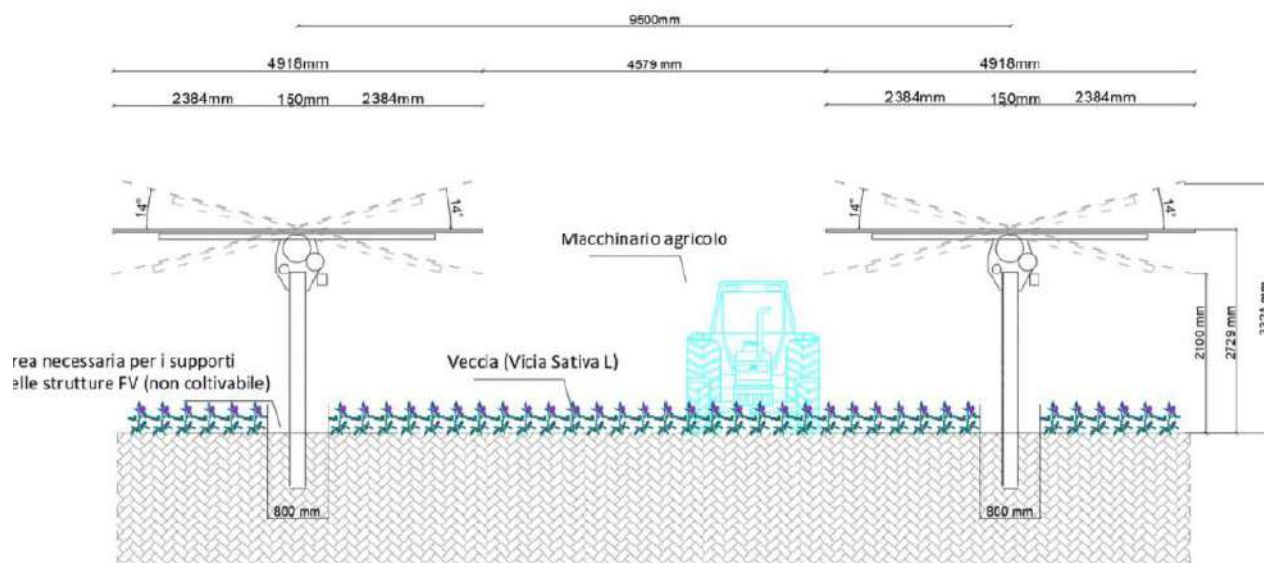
Sezione tipo strutture impianto “Valletta Solar”
